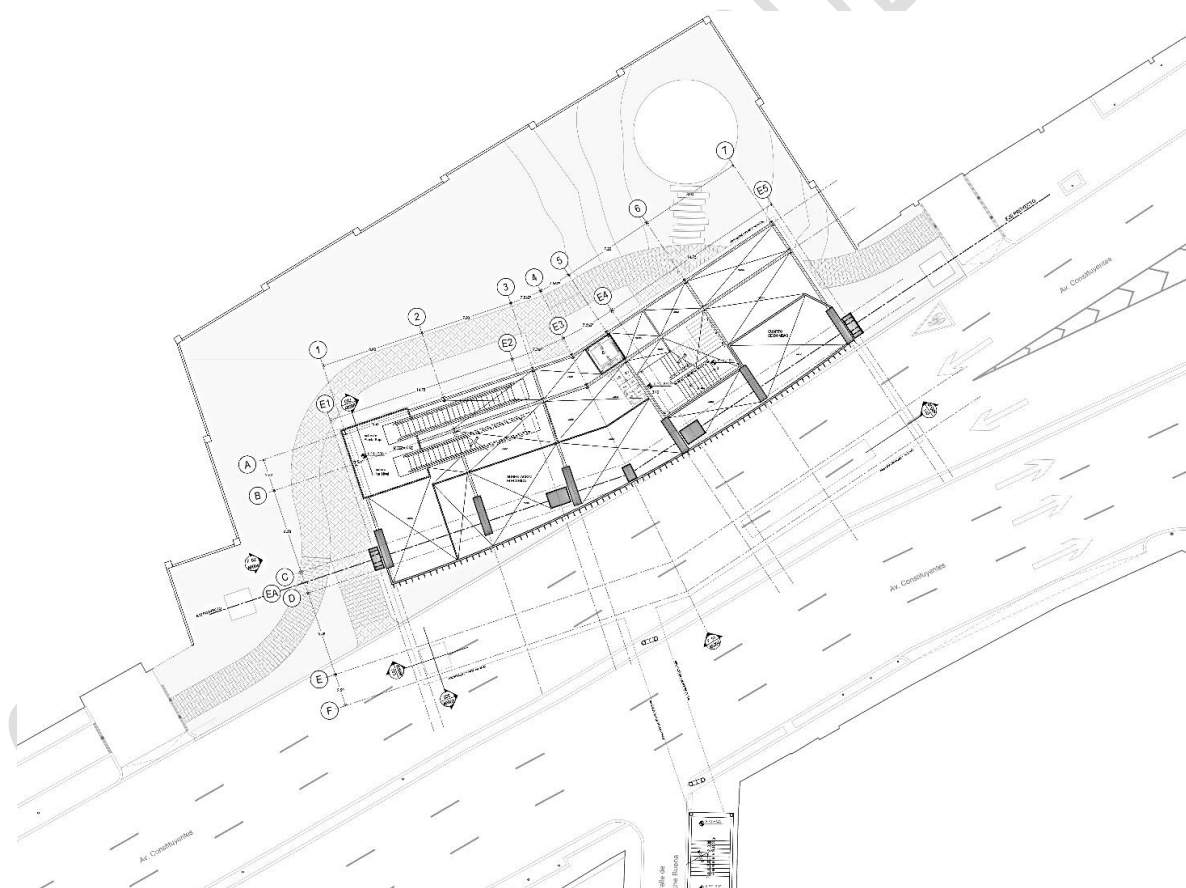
Planta Mezzanine Estación 4 Lienzo Charro
